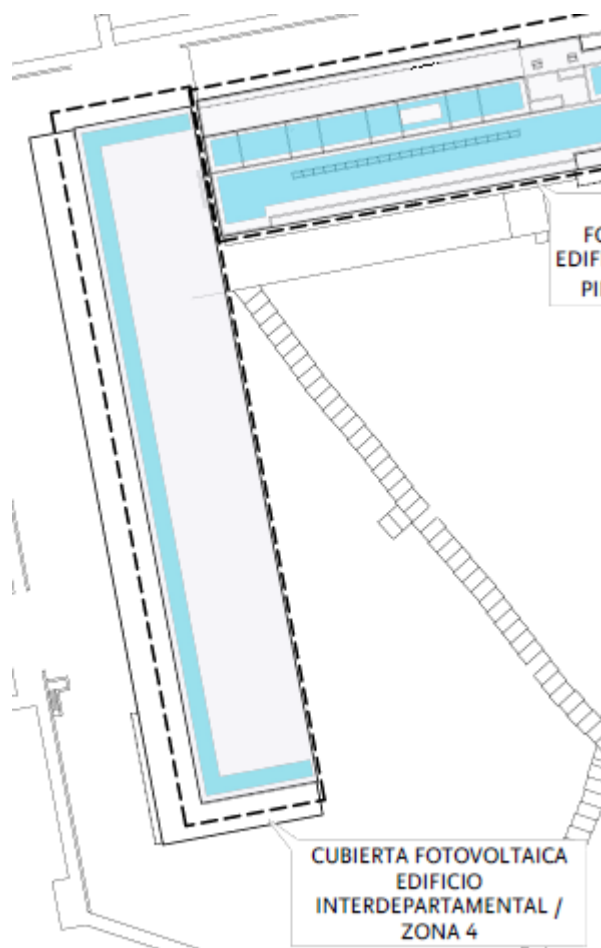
Disposición de las placas fotovoltaicas en la cubierta del edificio Interdepartamental
